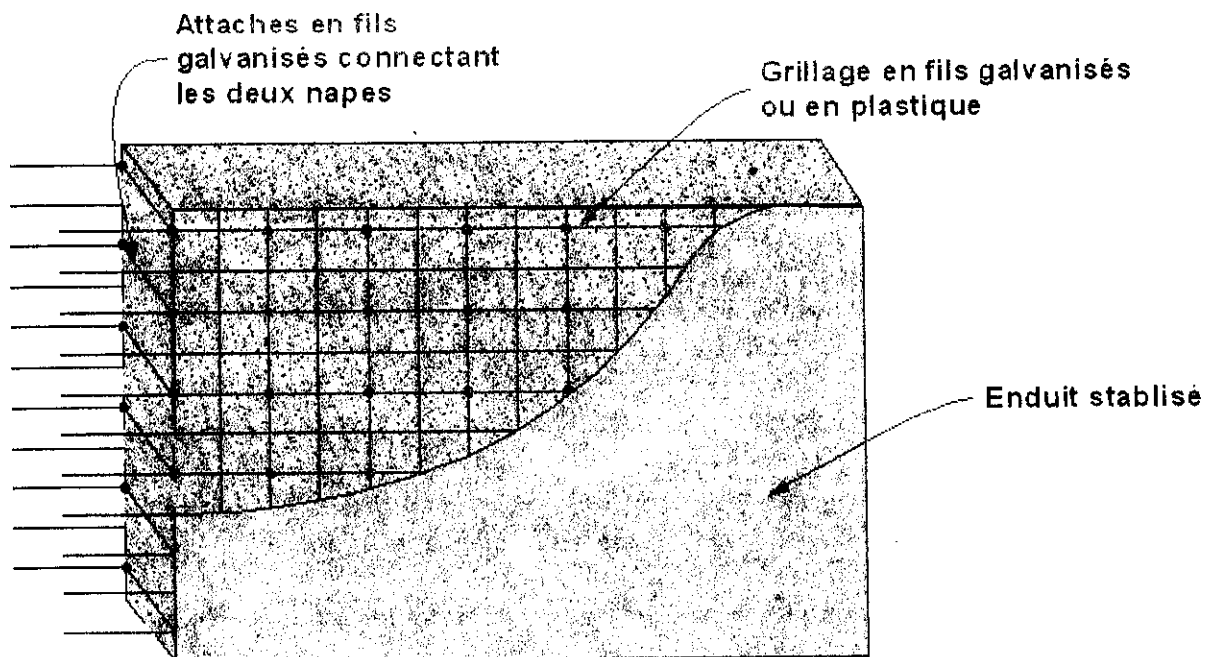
Renforcement latéral des murs par deux nappes en grillage
